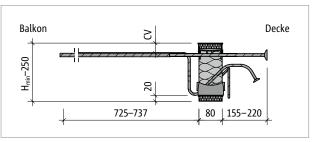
Schöck Isokorb® T Typ K-U-M4: Produktschnitt
